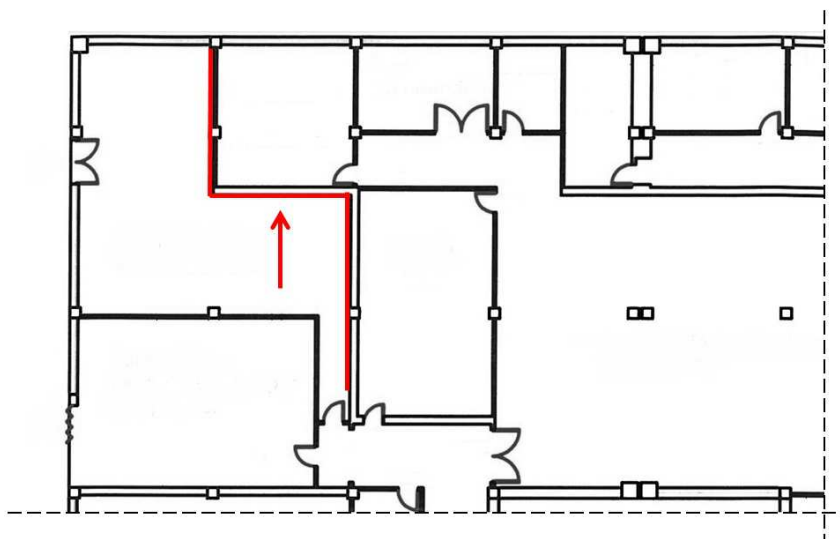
Localização da fissura, Planta do piso 0
